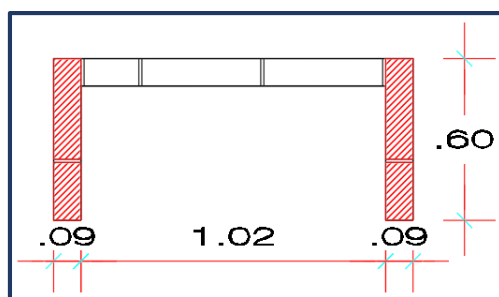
Esquema del Tipo 3 – Vista Planta.
